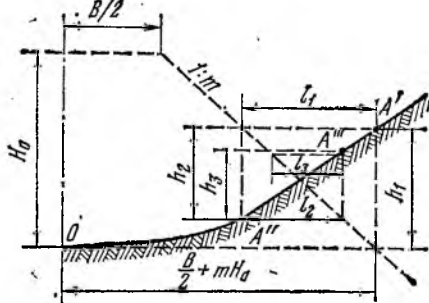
Схема разбивки насыпи вверх от ее оси
